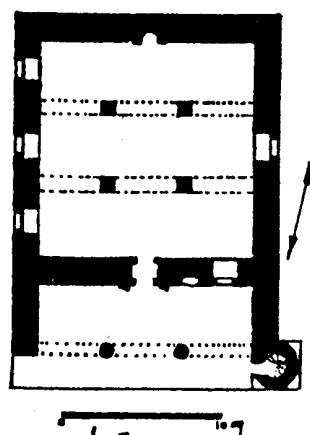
مسقط أفقي لجامع بابا آدم في رامبال بالبنغال
